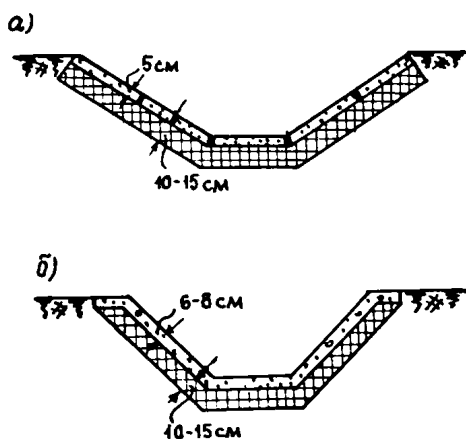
Укрепление водоотводных канав: а - плоскими армоцементными или железобетонными плитами; б - фасонными железобетонными блоками
